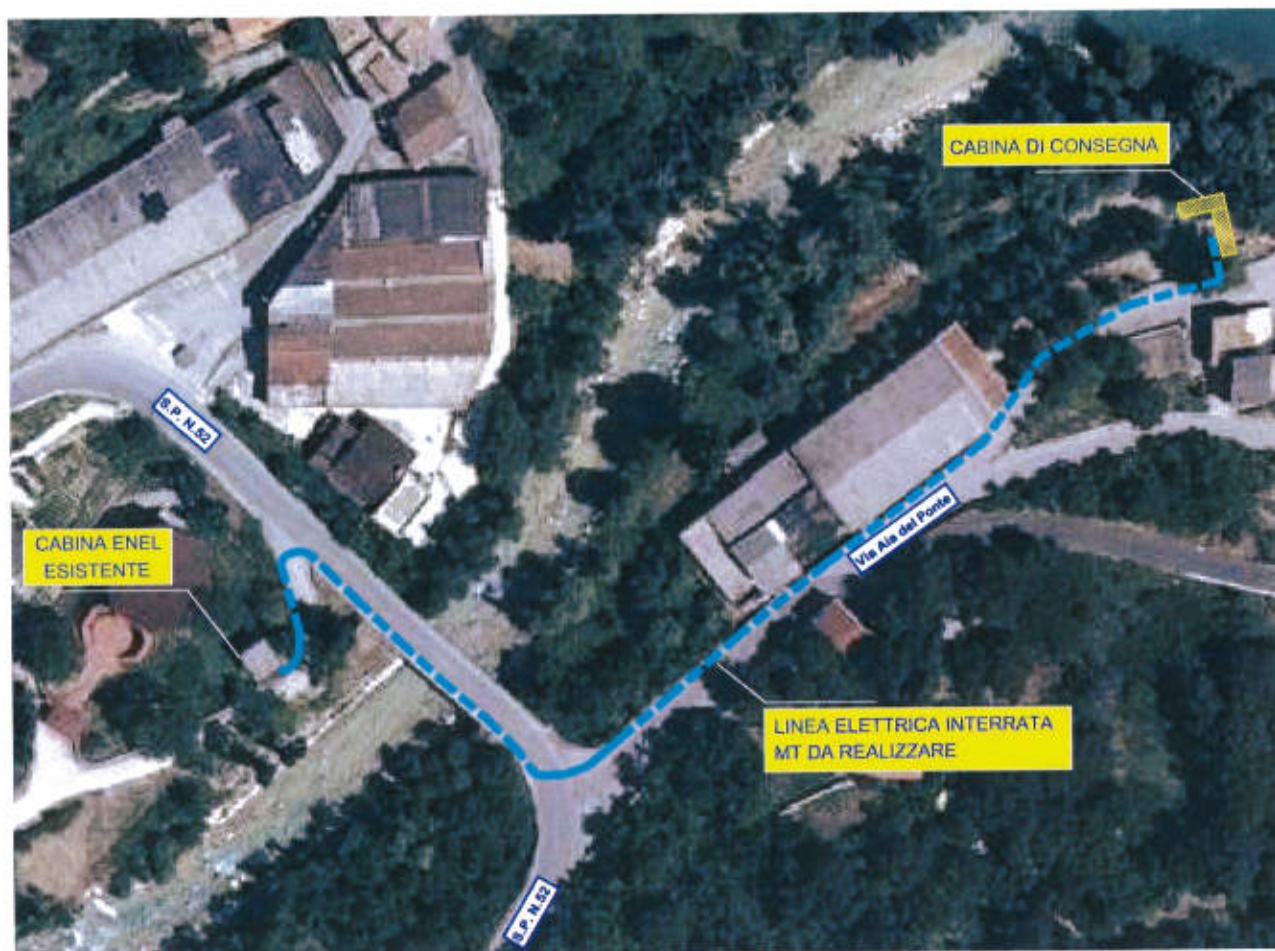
Planimetria su ortofoto delle opere di connessione alla rete.
